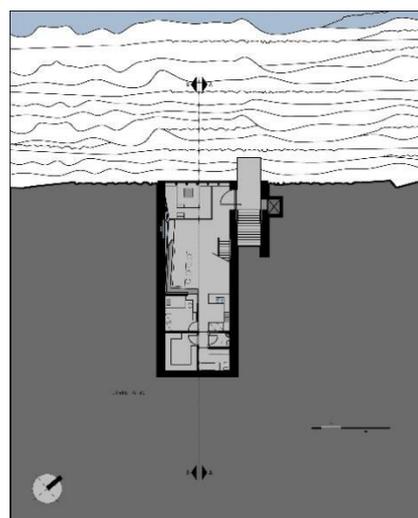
Casa Brutale [1], план этажа Casa Brutale [2]
